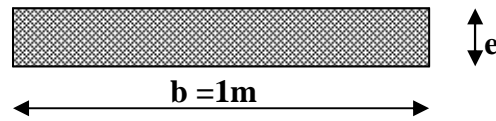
Section de la dalle pleine 'b' à ferrailer
